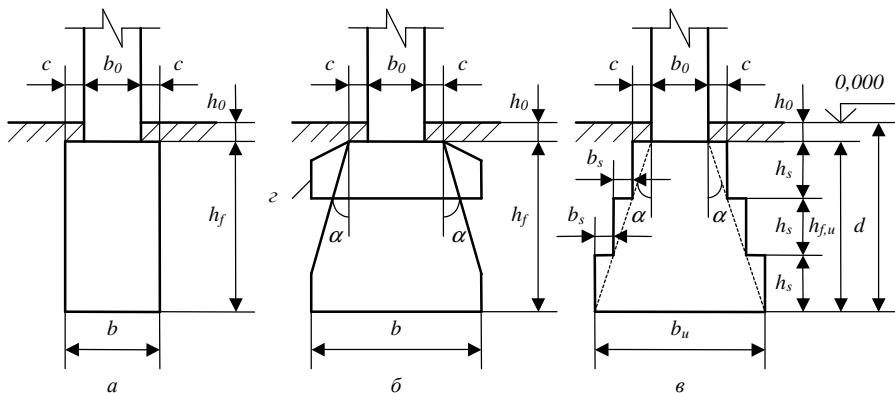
Схеми поперечного перерізу жорстких фундаментів:
